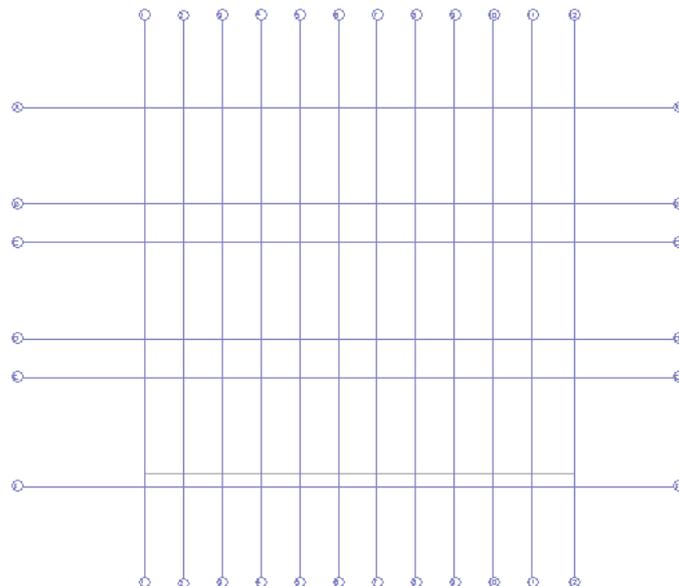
Ansicht Raster im Grundriss „EG“
